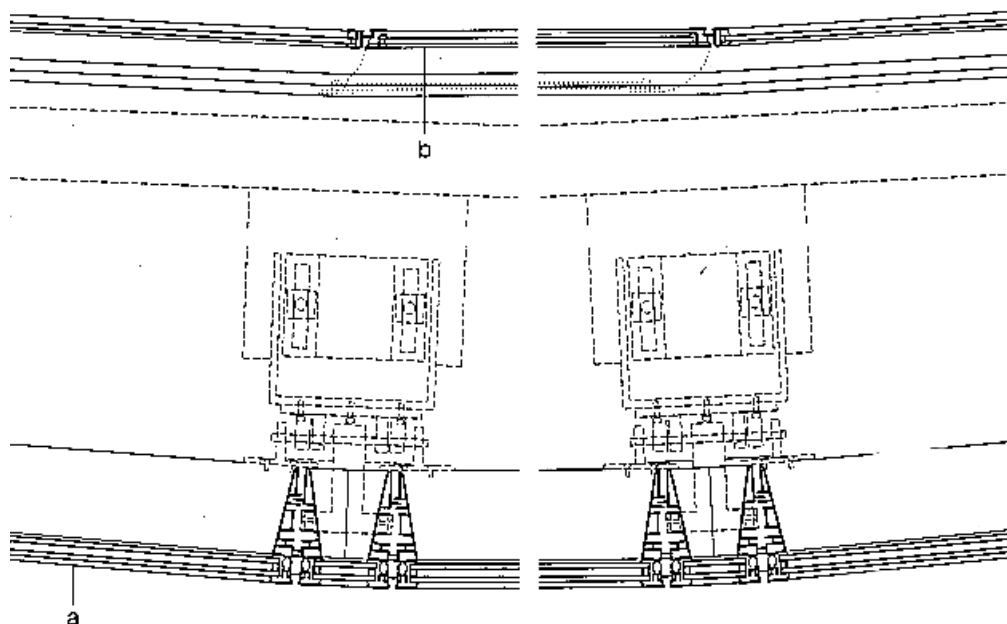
Штаб-квартира Swiss Re: схематический горизонтальный разрез: а – двойное остекление в алюминиевом каркасе: 10 мм закаленное стекло + 16 мм полость небующего стекла (2×5 мм); б – раздвижные двери: небующее стекло (2×5 мм) в алюминиевом каркасе
